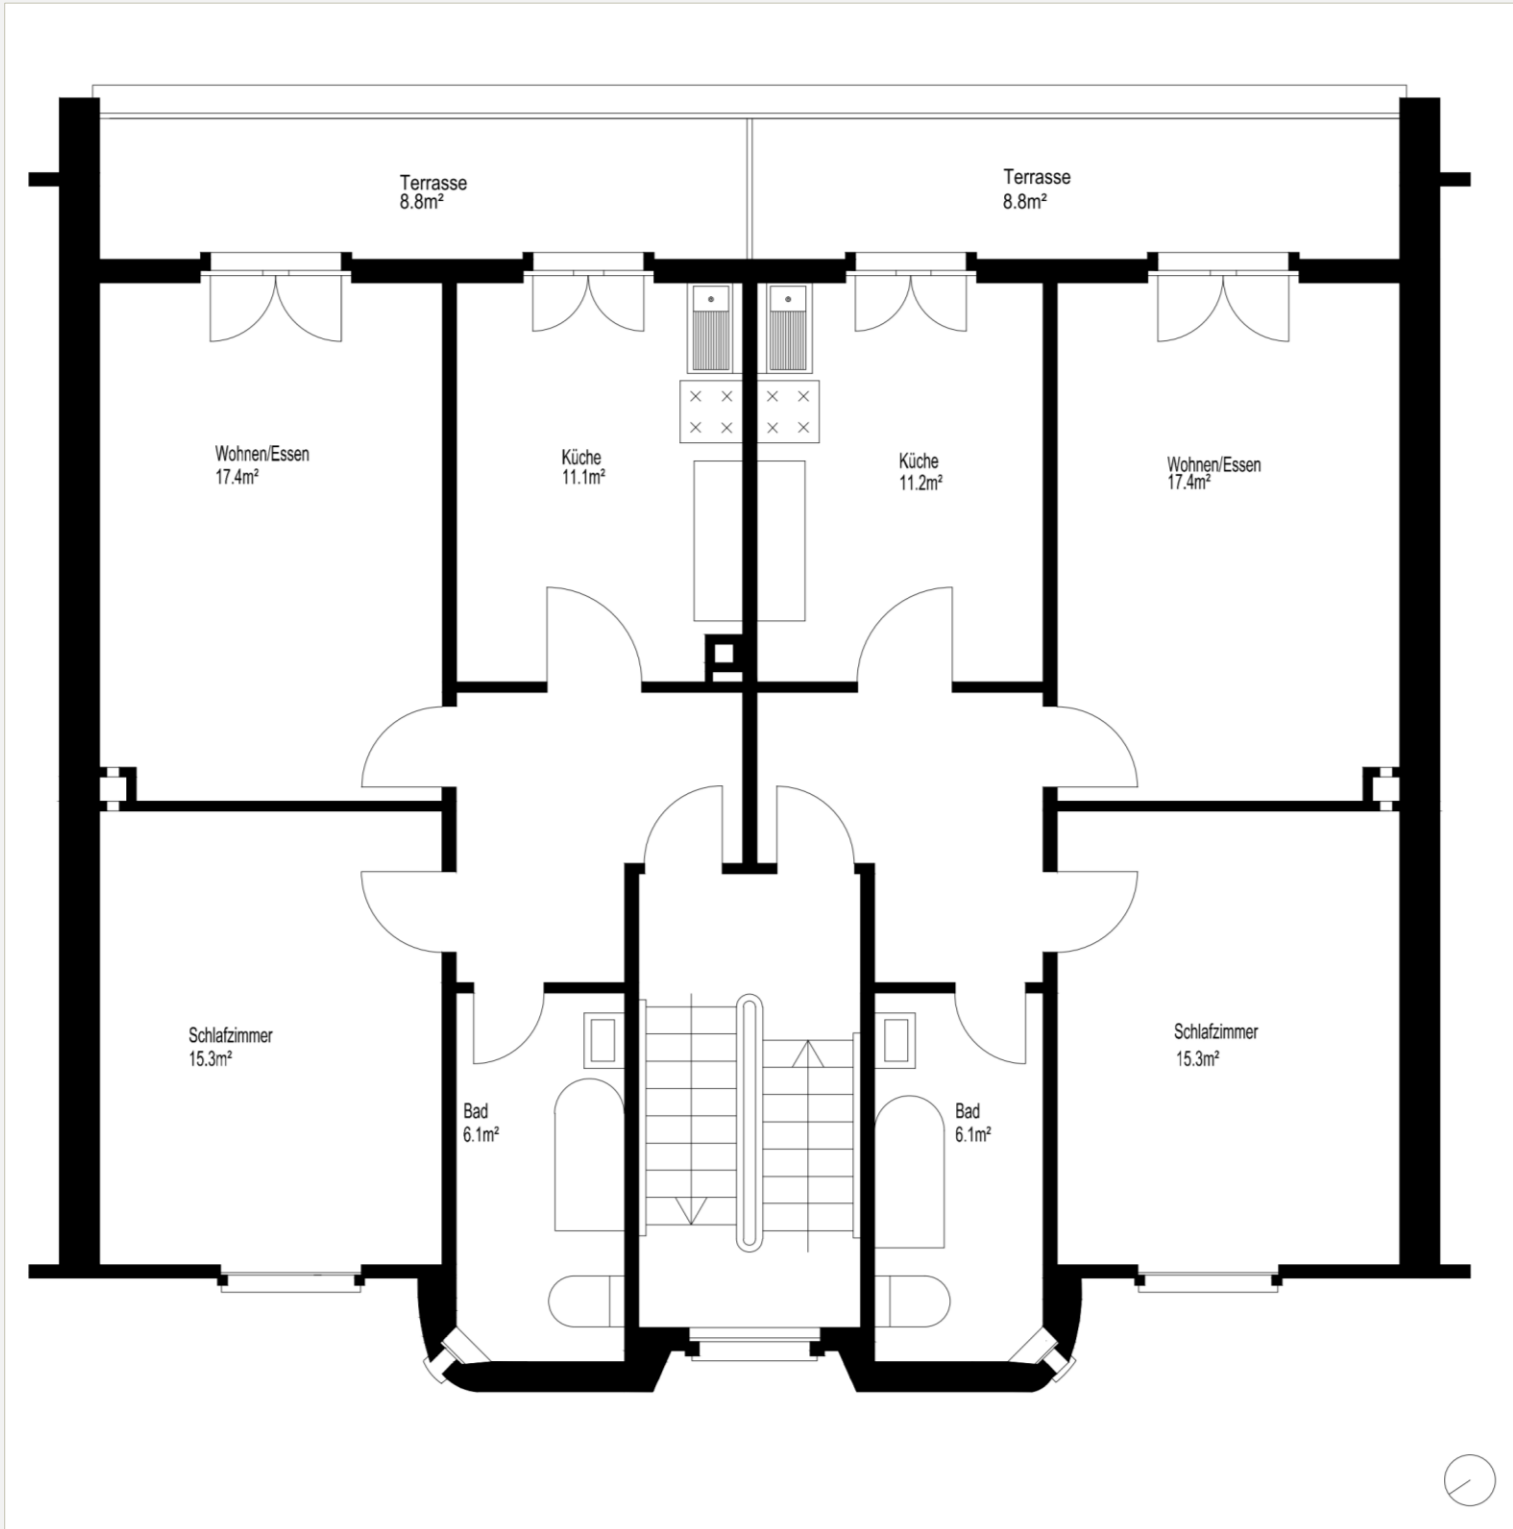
typischer Grundriss der Mülhauserstrasse 73
